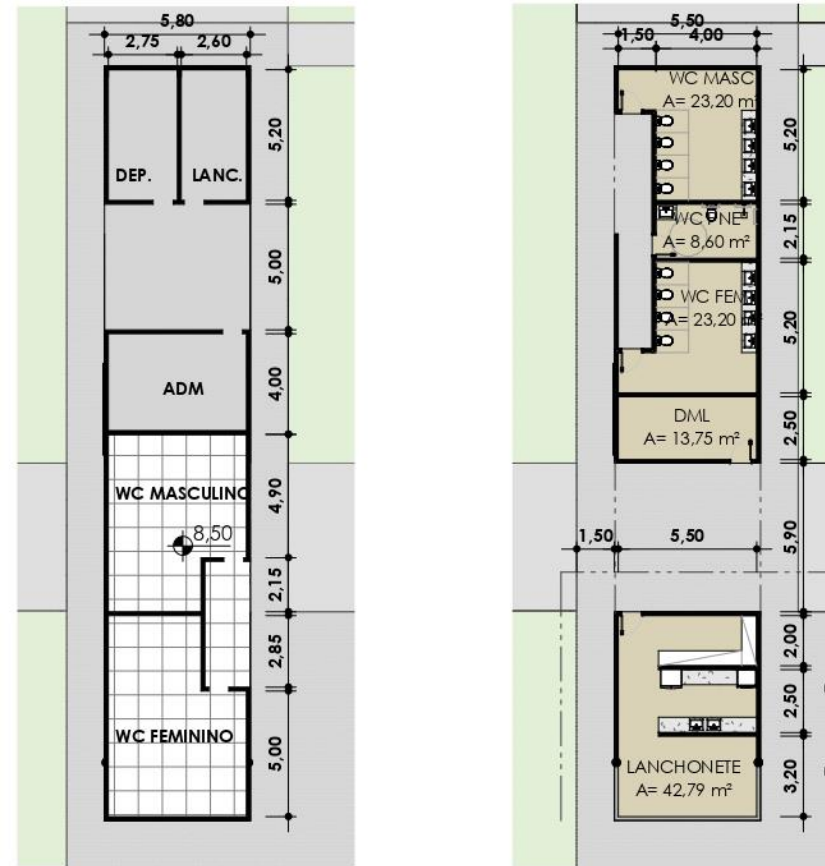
Edifício anexo - Planta atual e planta da proposta |
